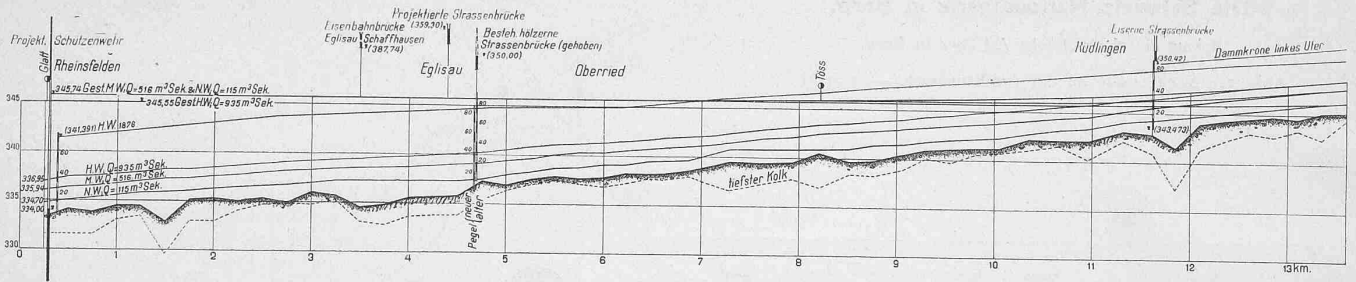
Längenprofil der Staustrecke. — Masstab für die Längen 1 : 70000, für die Höhen 1 : 700.
